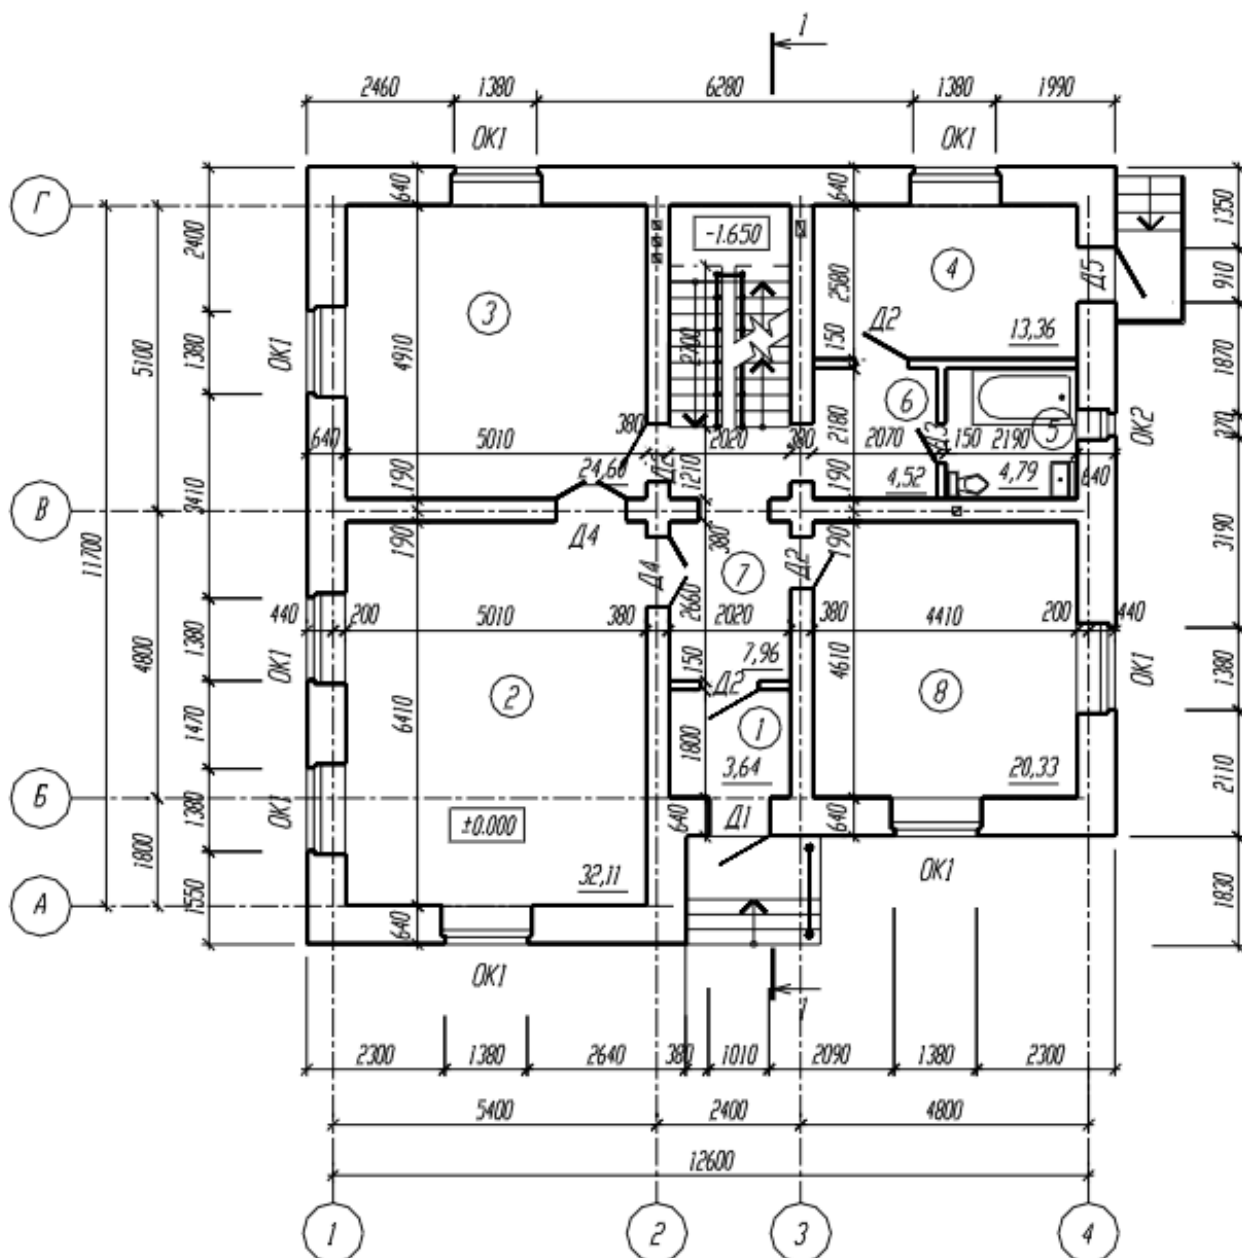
Пример оформления плана 1-го этажа жилого дома, со стенами из мелкоштучных материалов.
